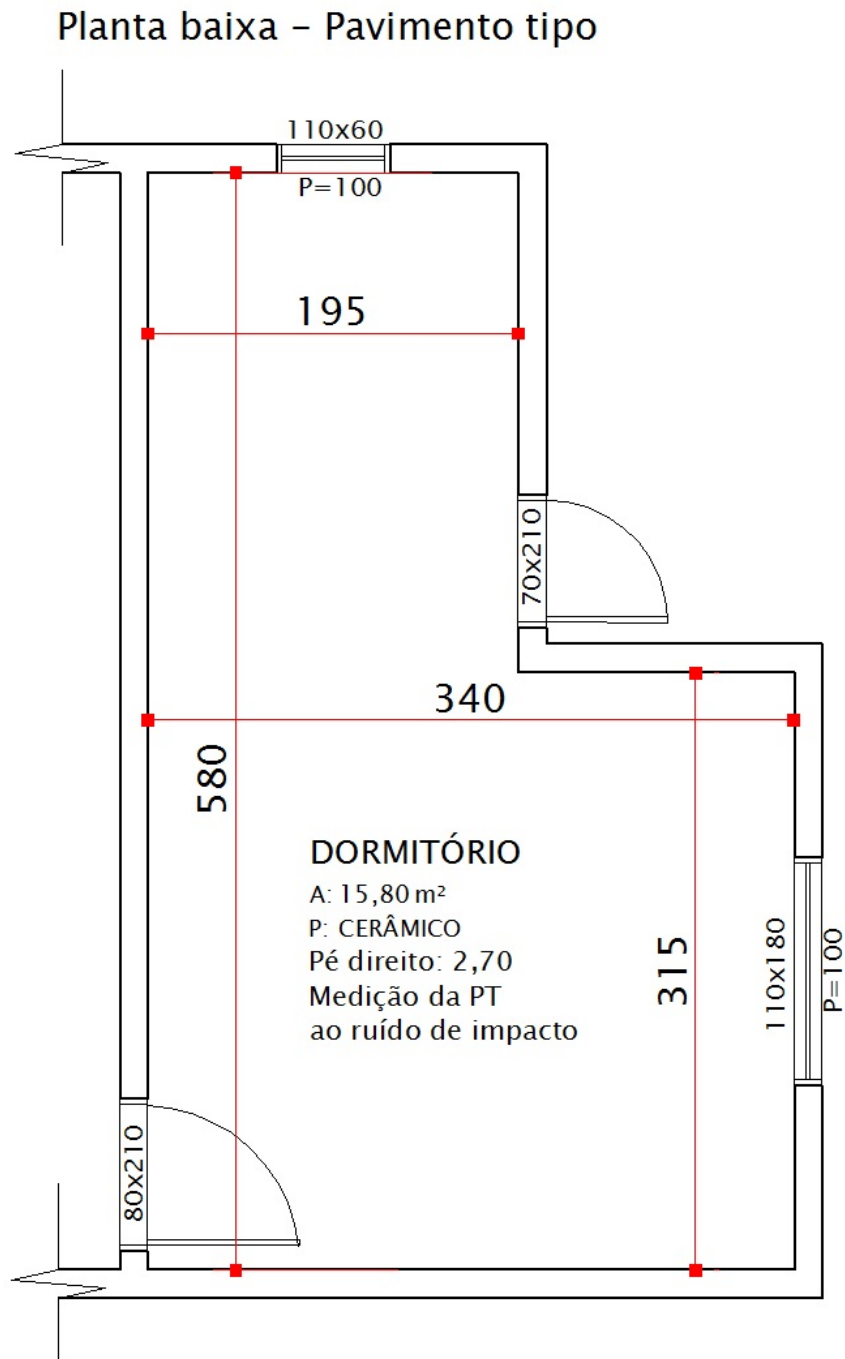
Planta baixa - pavimento tipo - 20-R8-A-PC
